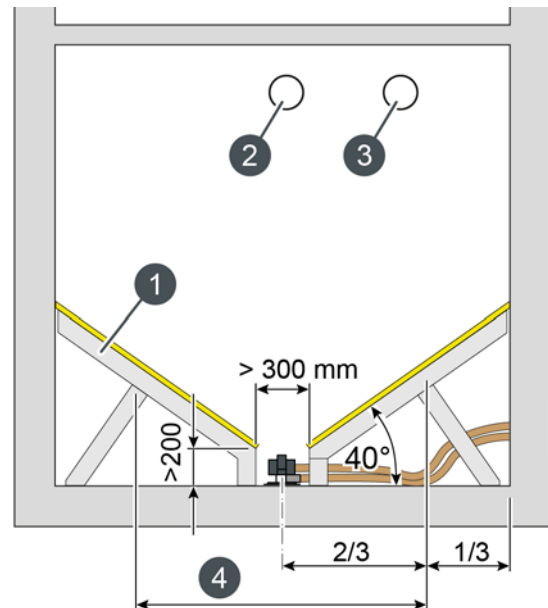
Construction du plancher incliné en cas de sondes d'aspiration
